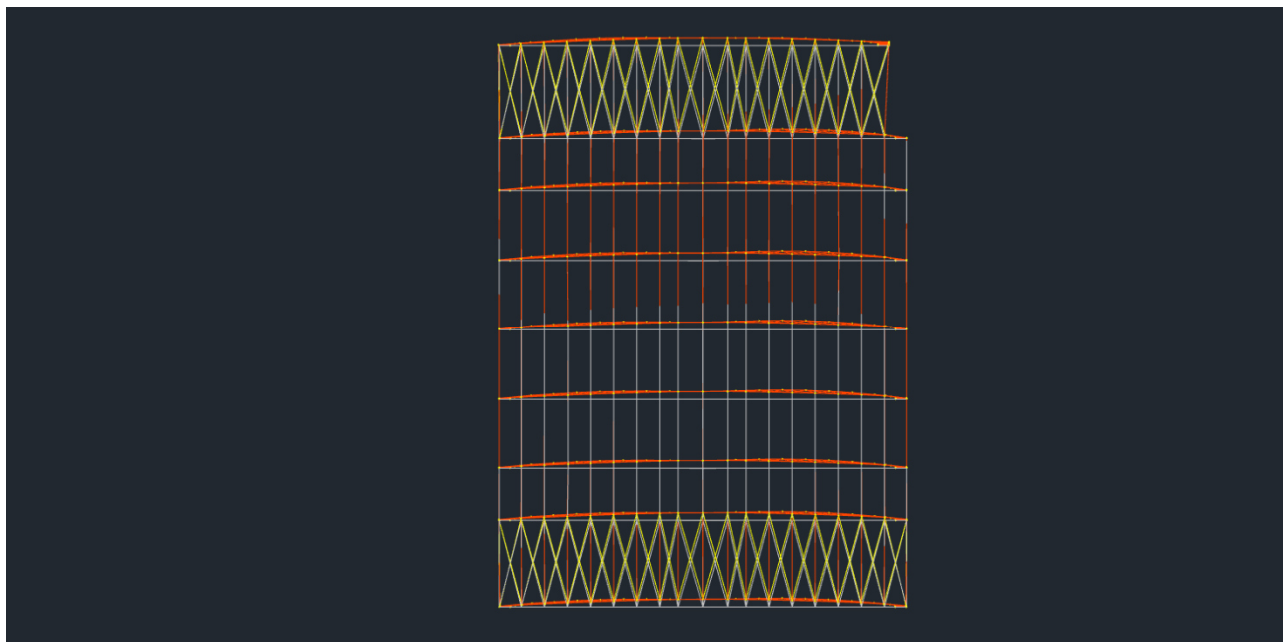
Spostamenti 1° Modo di vibrare - Vista in pianta
